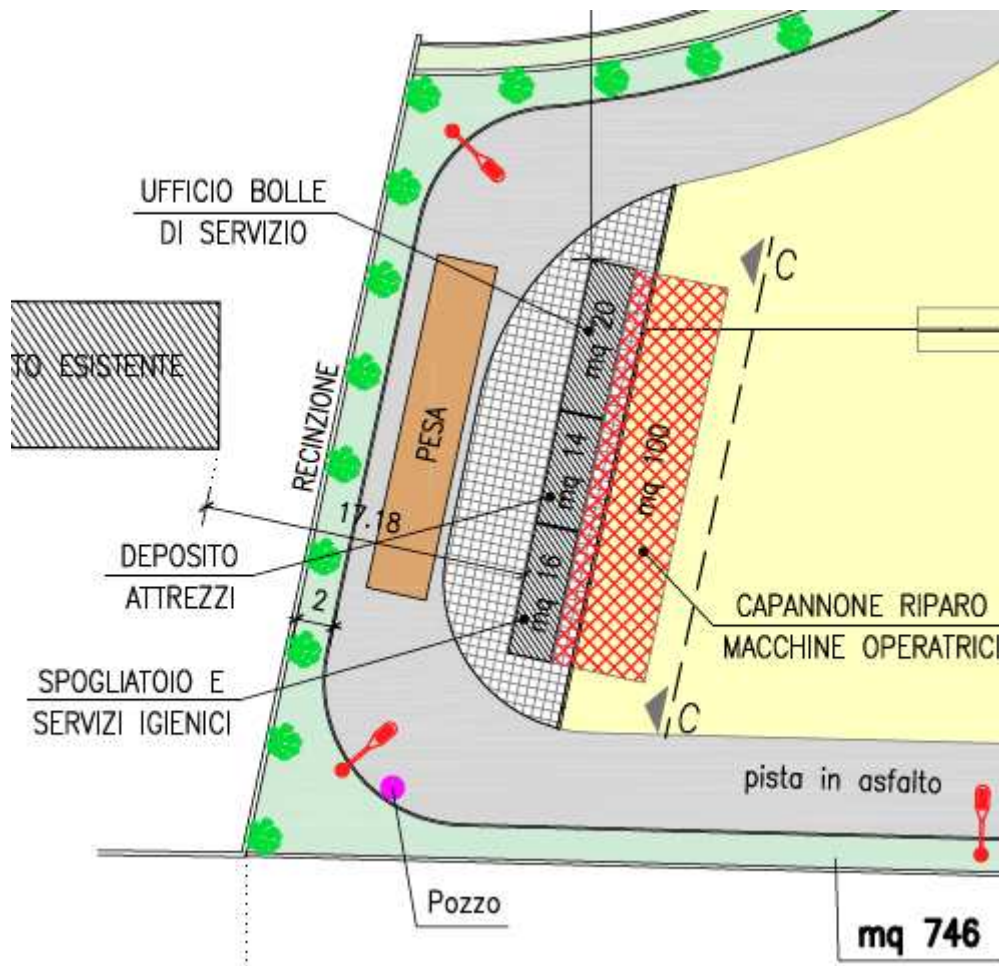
Posizionamento della zona uffici e pesa (lato est del sito; stralcio dalla Planimetria del PdC) ed eventuale tettoia (II° stralcio).
